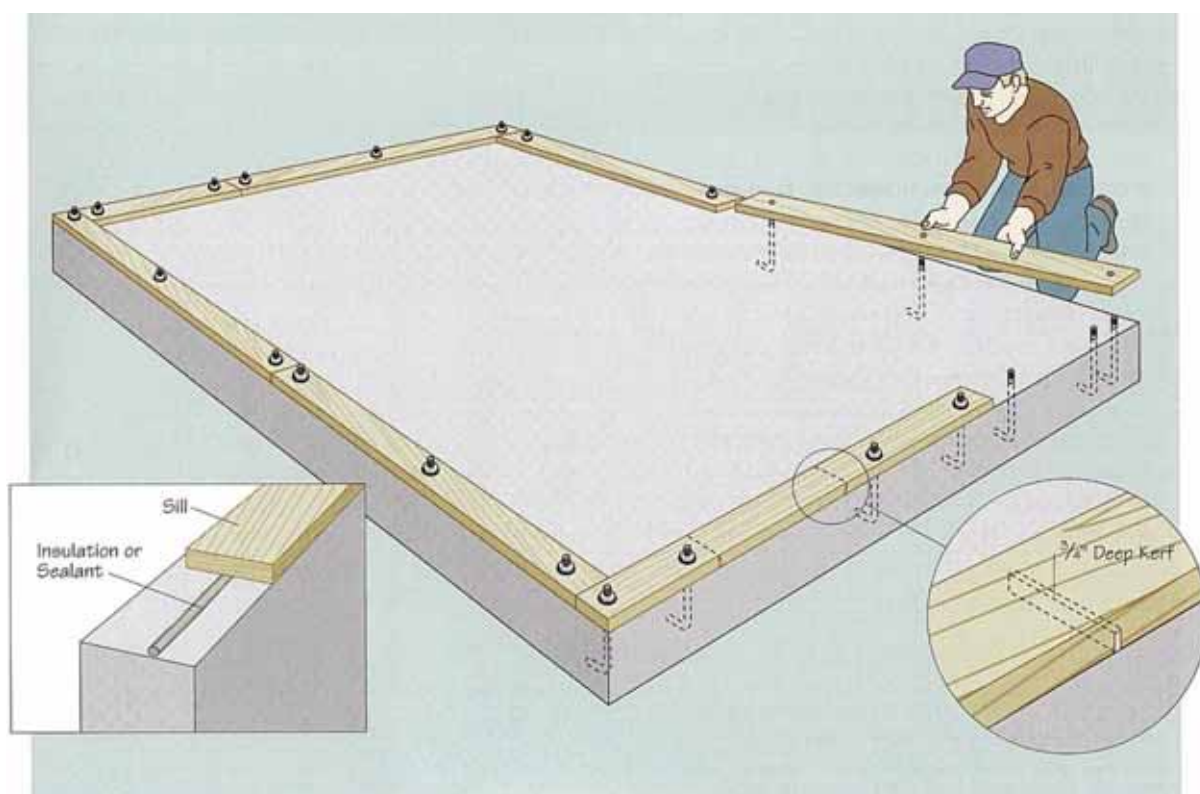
Ligação de peças de madeira com a fundação em radier.
